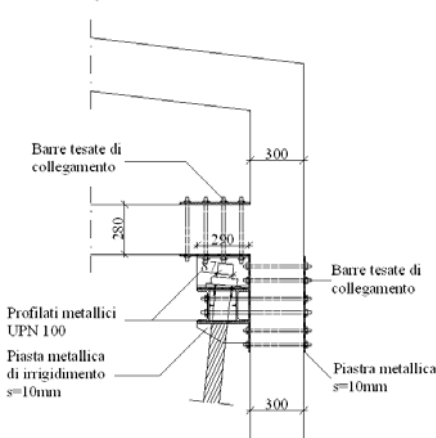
Ancoraggio superiore del cavo e relativo dettaglio d'installazione (particolare 3 di Figura 19)
